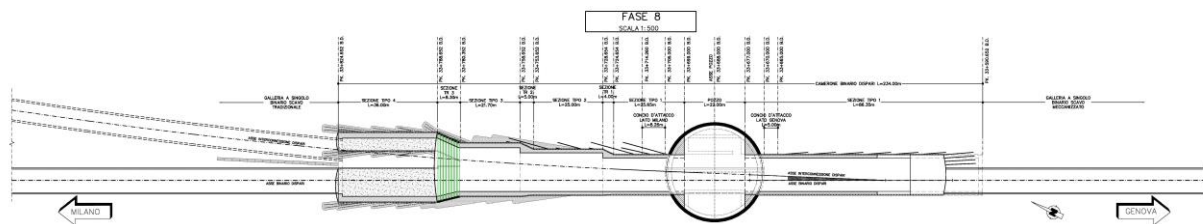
Avanzamento piena sezione lato Genova e scavo allargo di calotta lato Milano
